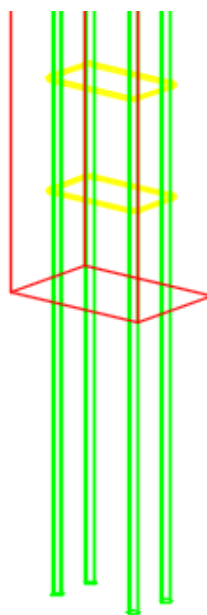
Pormenor 2 - barra (Piso 2 – Piso 3).
